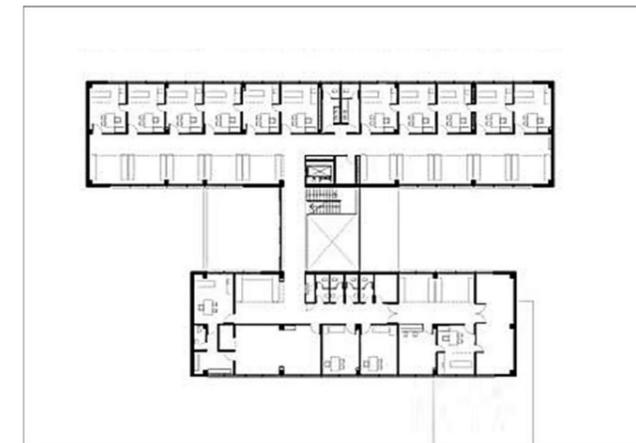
Planta arquitectónica del Centro Fuente: Corea (2007)
